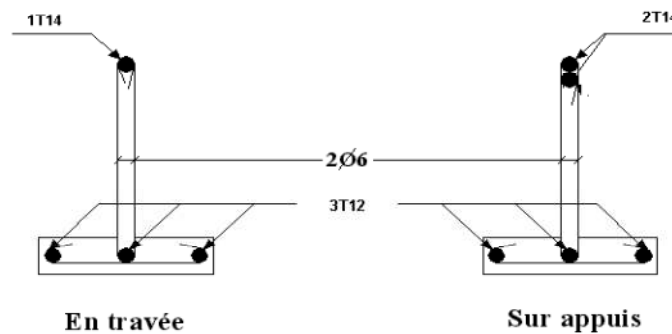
ferrailage des poutrelles en travées et sur appuis.
